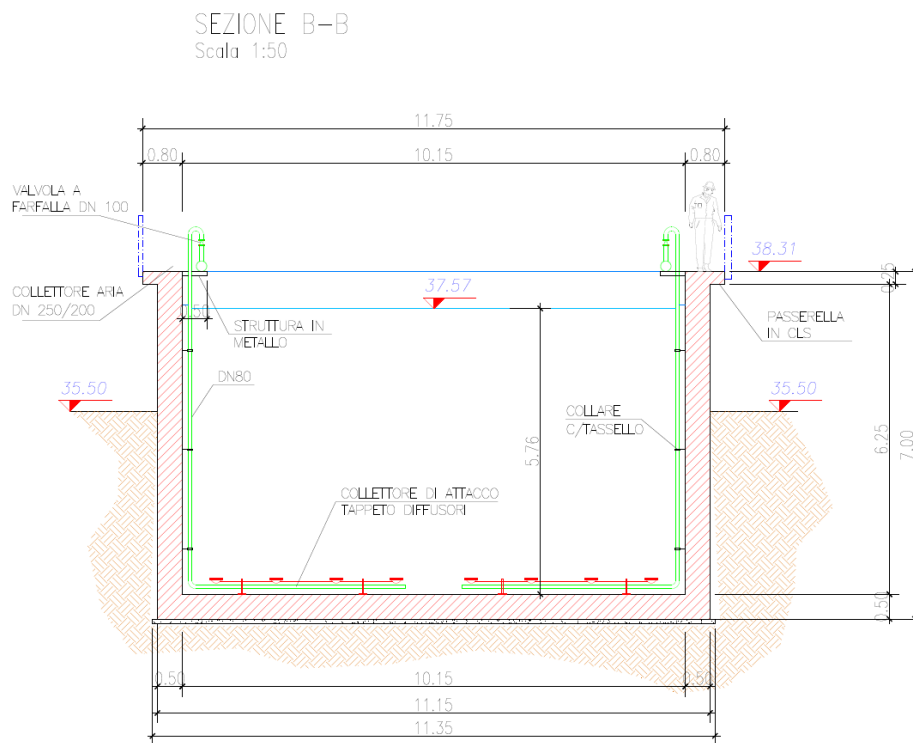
Pianta e sezioni Vasche a Cicli Alternati
